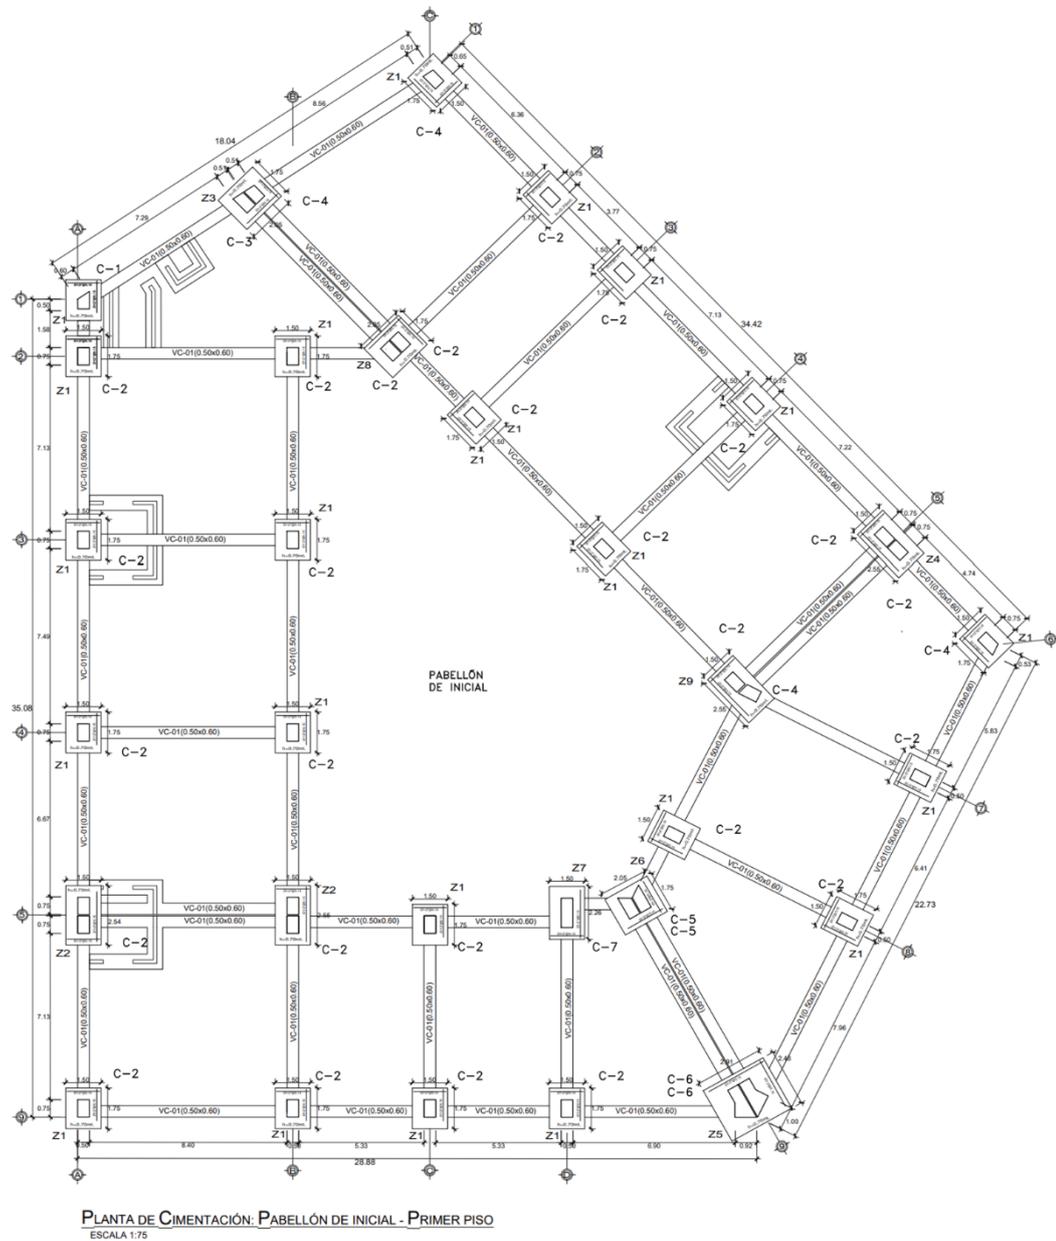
Zapatas II. Ver plano E02_Plano de Estructuras del pabellón de inicial, Elaboración propia.
